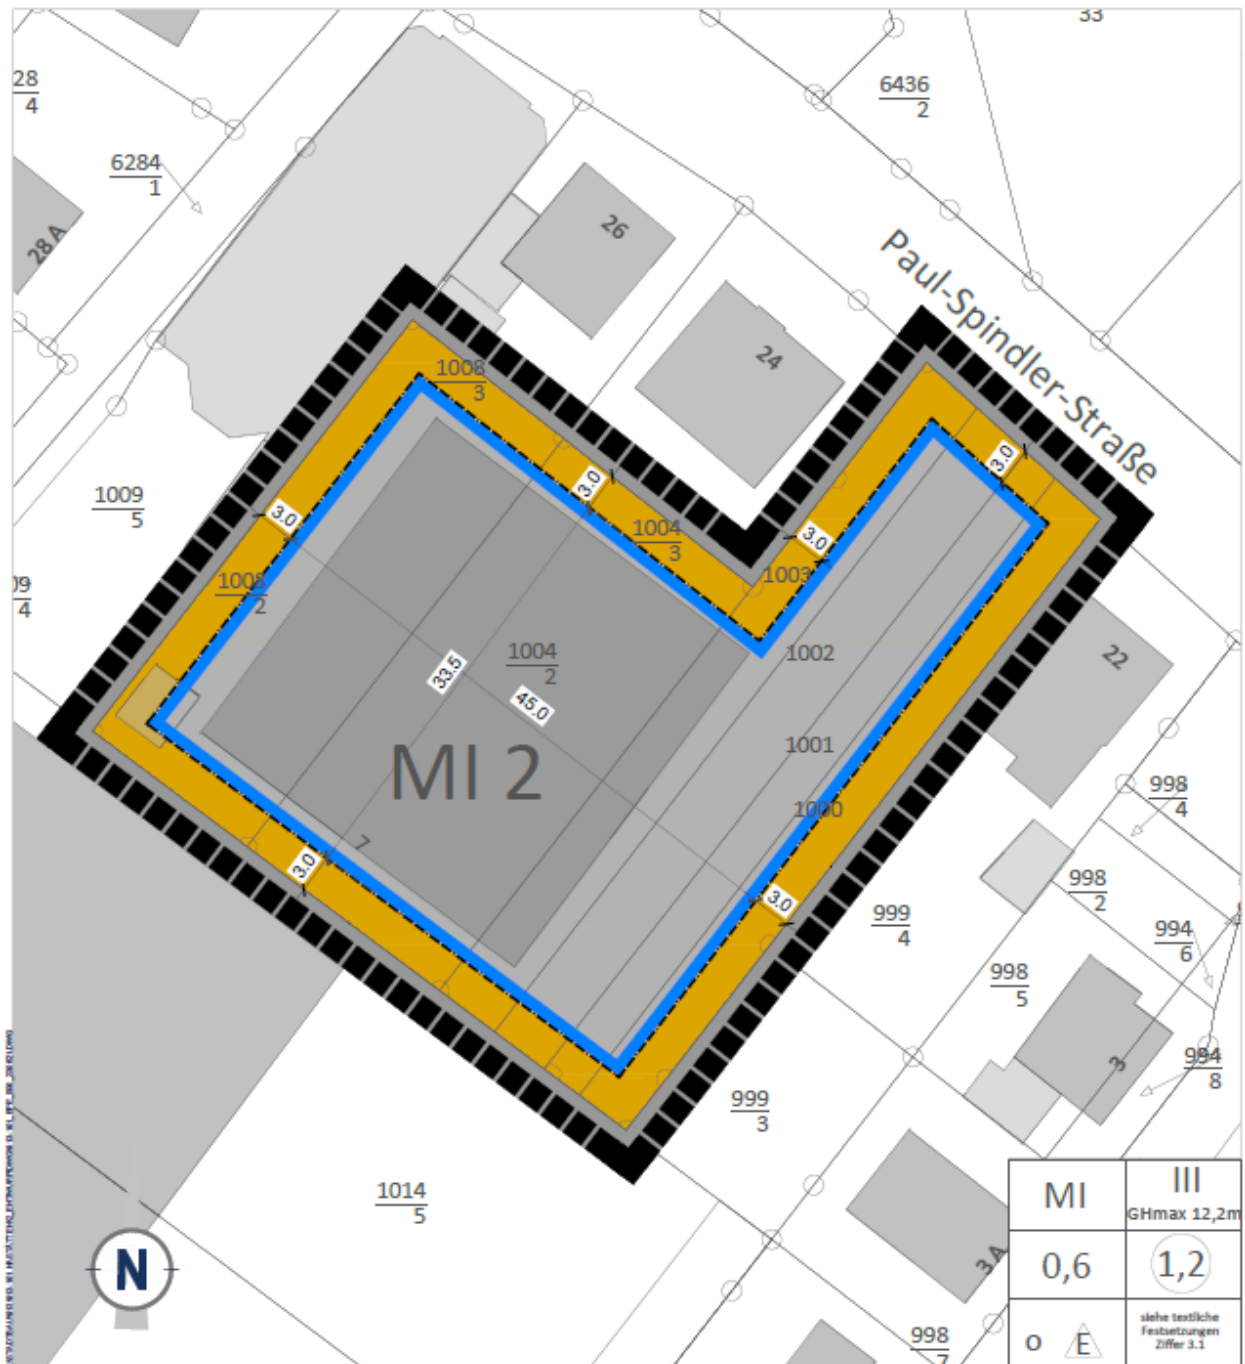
Entwurf des Bebauungsplans „In der Au-2.Änderung“
